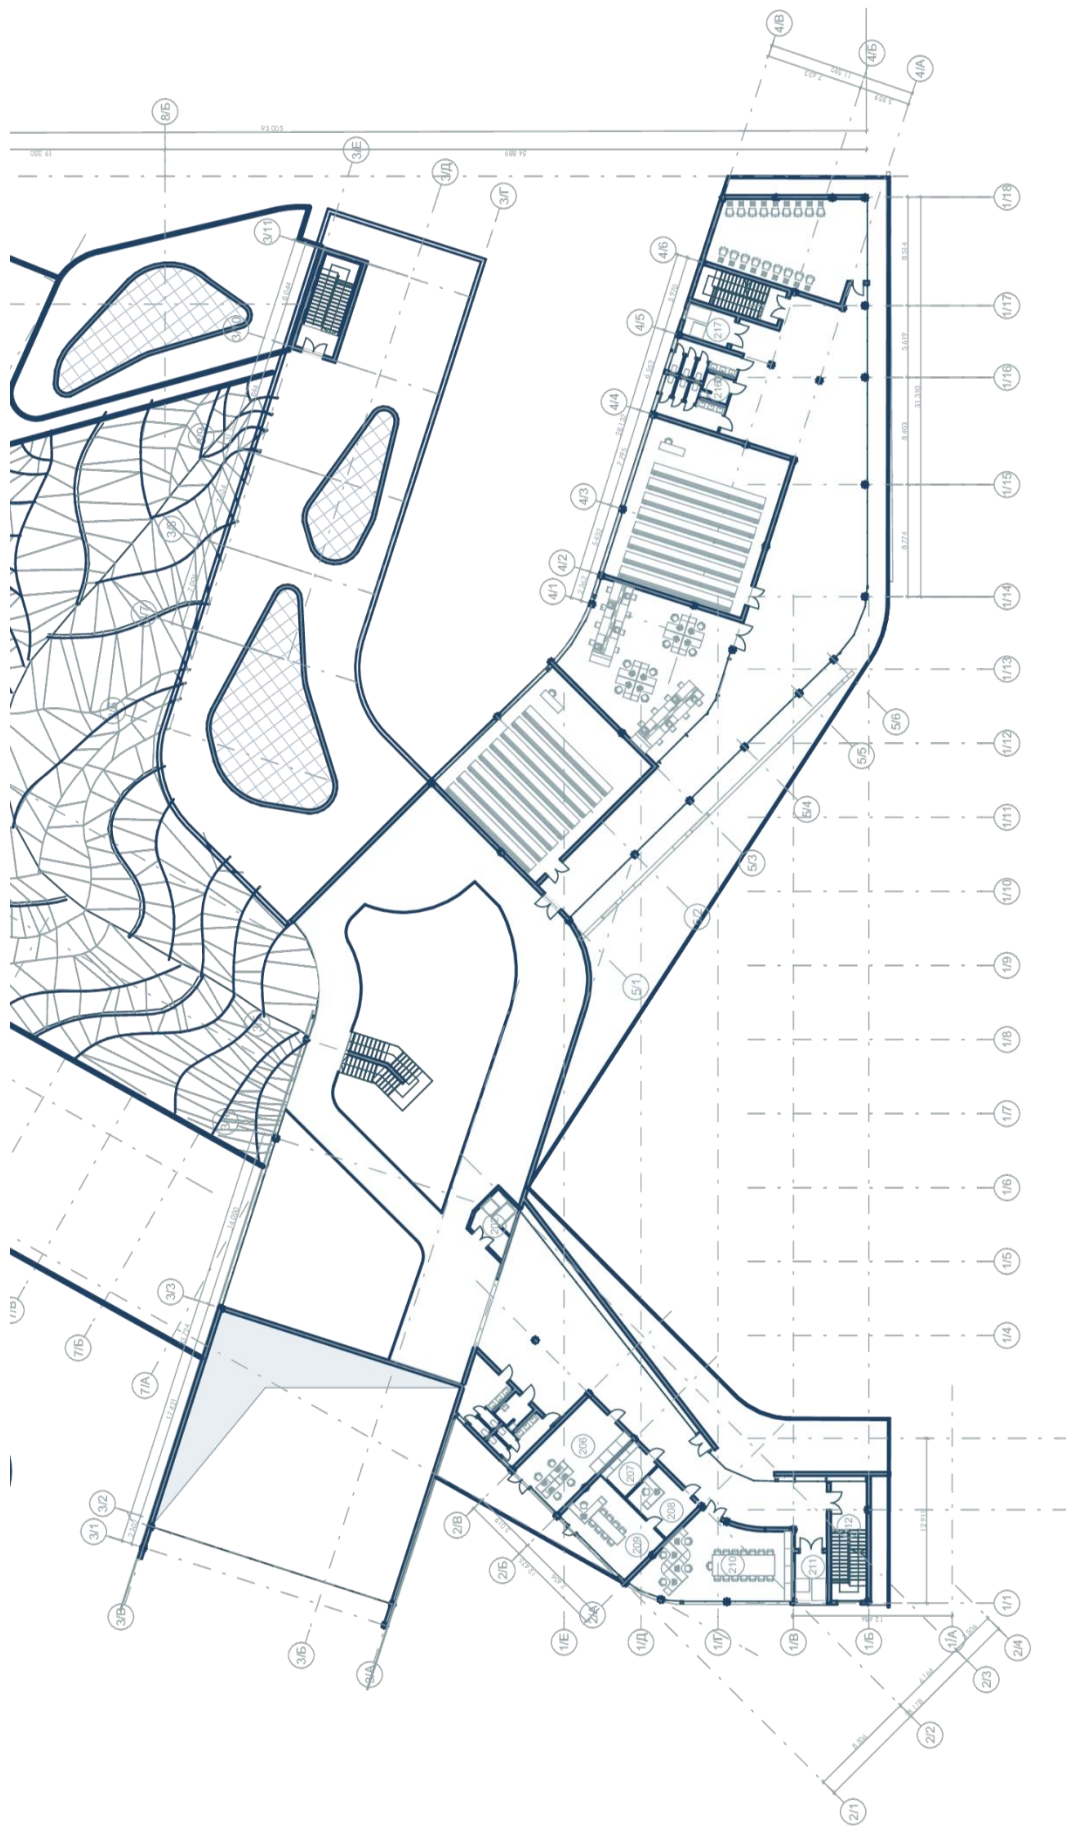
Фрагмент плану 2 поверху на відм. +4.200
